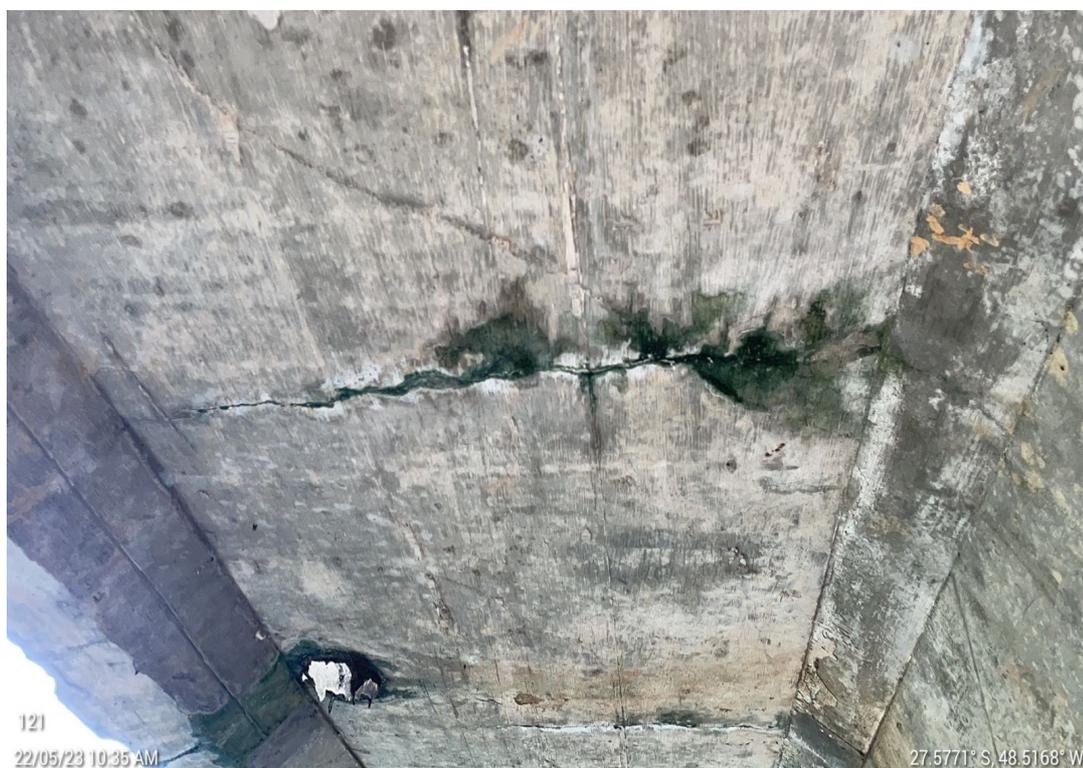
Superestrutura – Tabuleiro Lajes em balanço com fissuras com acúmulo de umidade.
